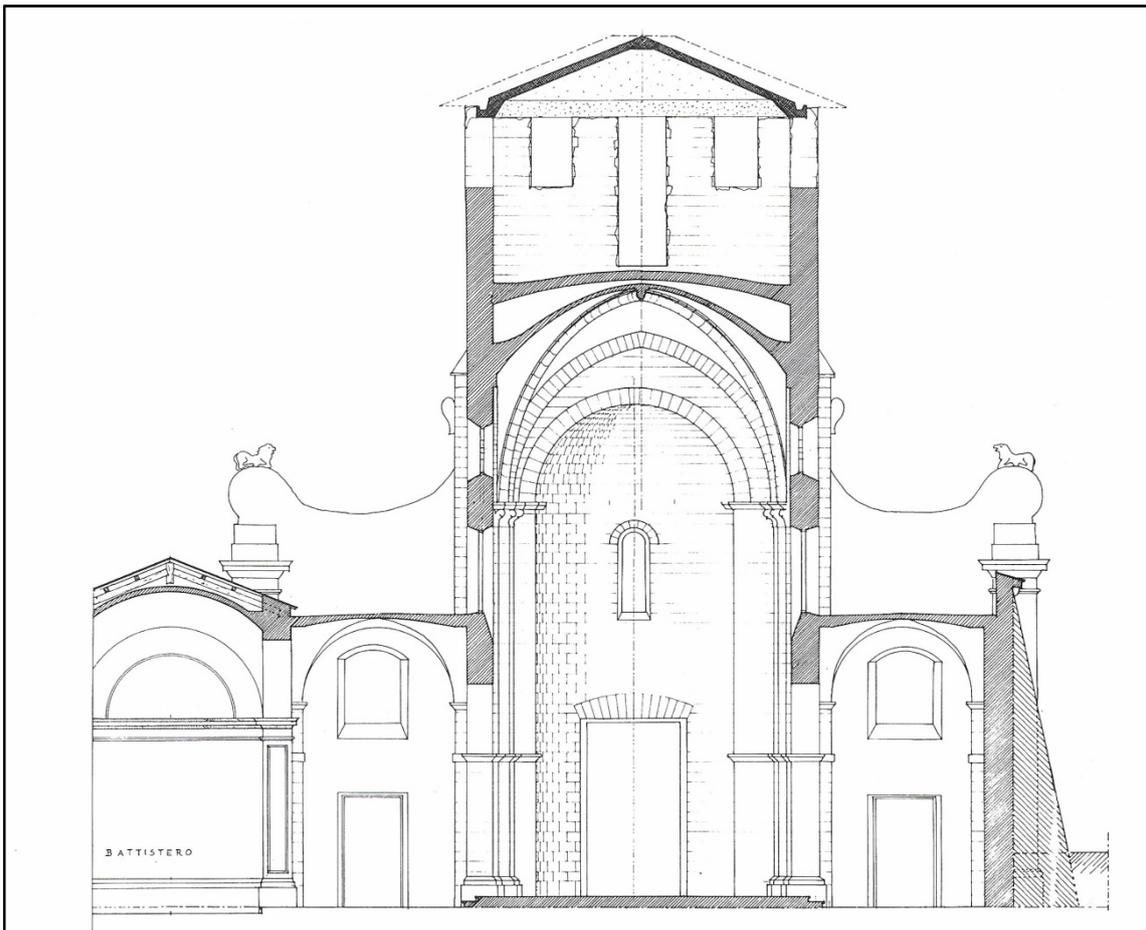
1968 - Disegno di progetto per il restauro della Cattedrale - sezione trasversale (APZ)
